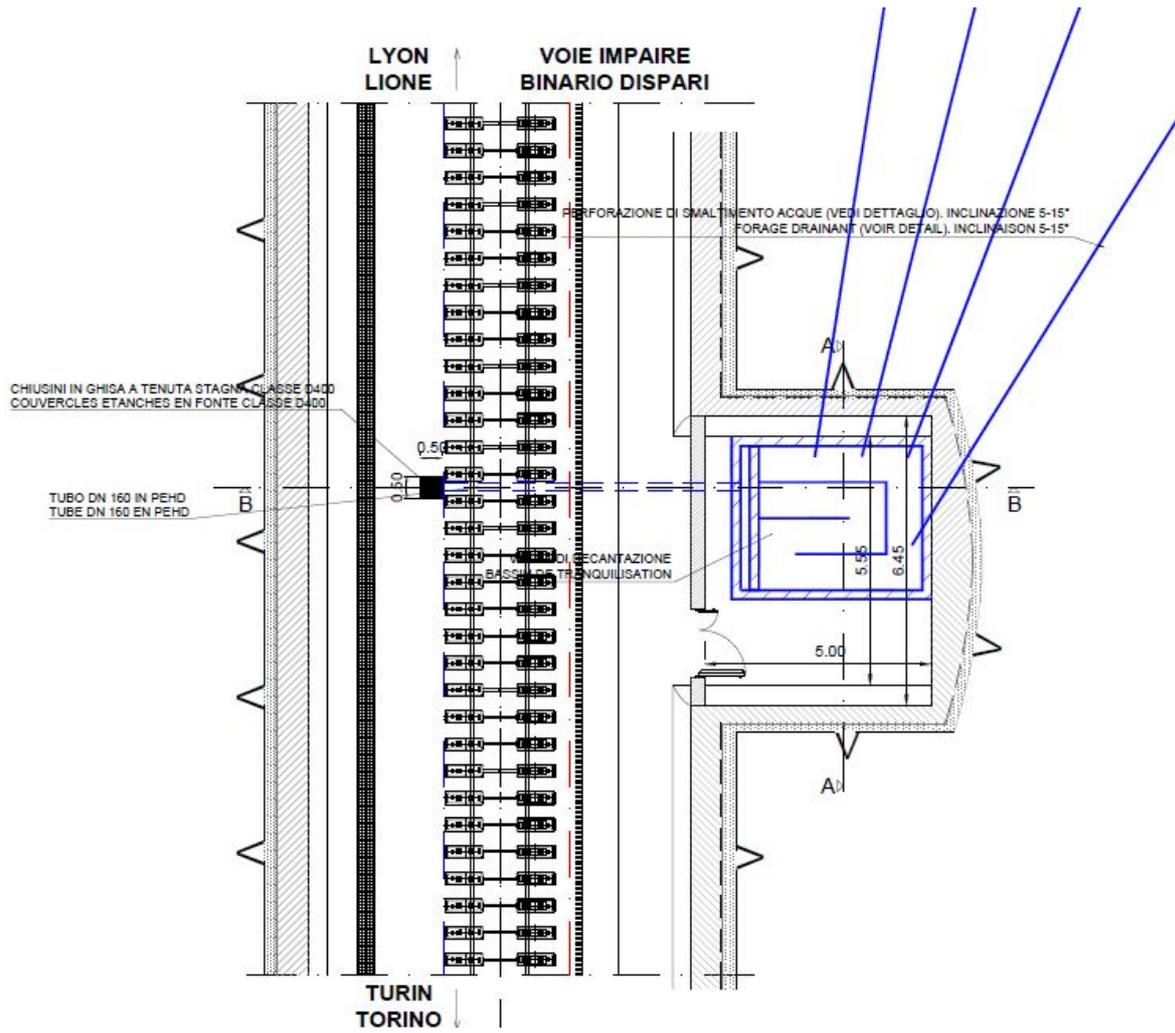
Sistema di captazione delle acque calde potenzialmente potabili. Planimetria
